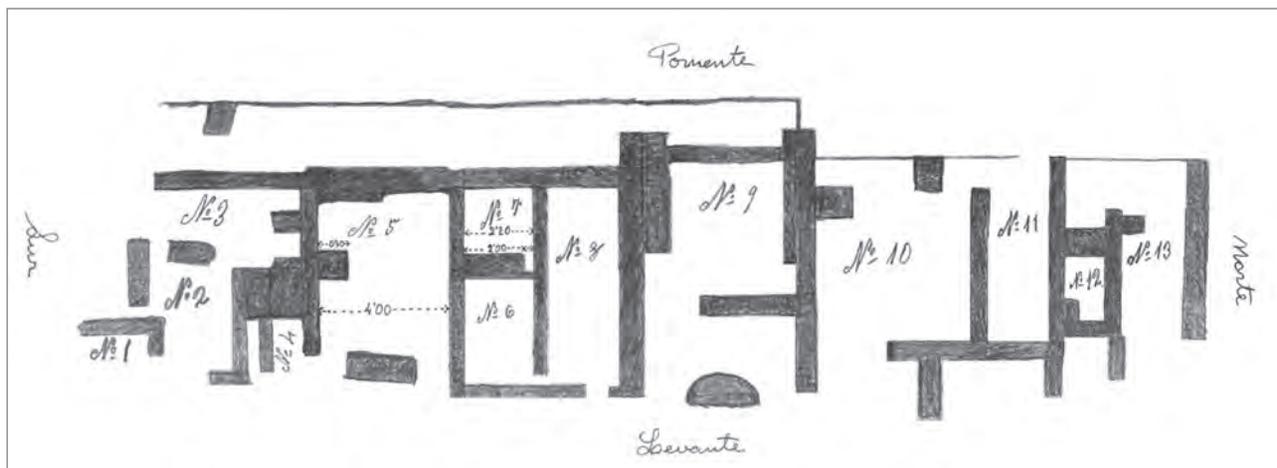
Plano de las estructuras descubiertas por Figueras Pacheco en 1935 en el extremo sureste de la zanja.
